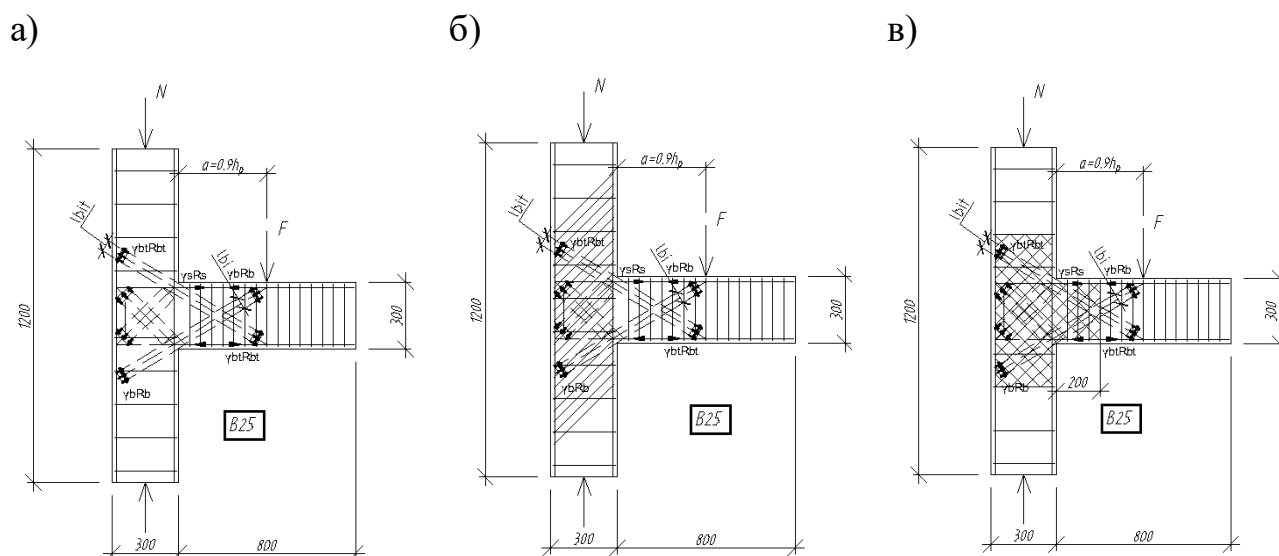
Армирование центральной части узла с элементами каркасно-стержневой модели при вариантах армирования: а – №1, б – №2, в – №3
